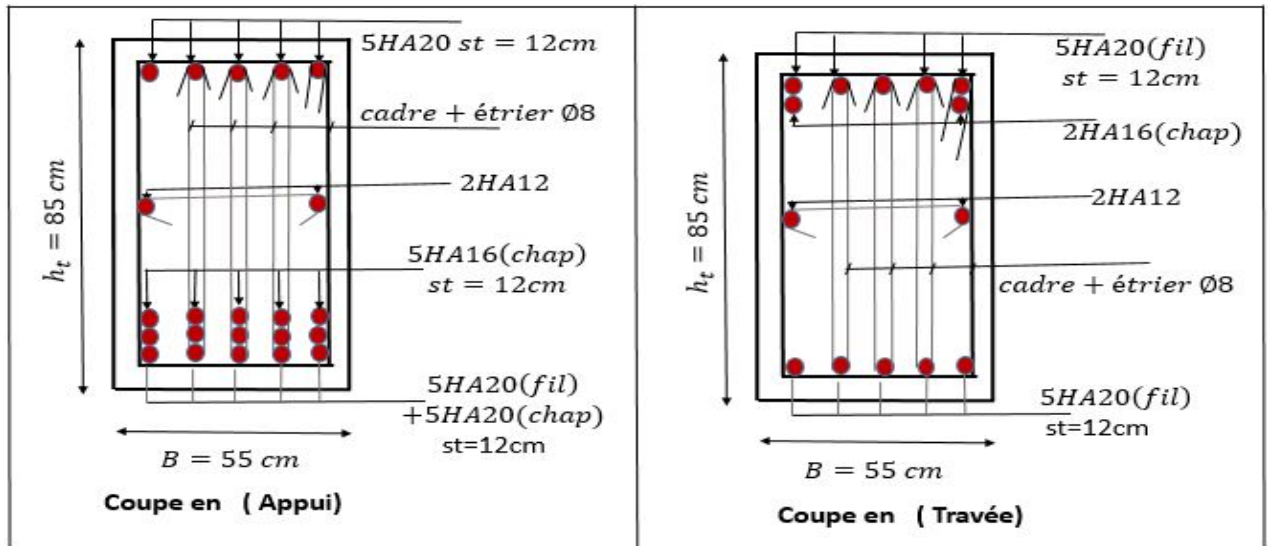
Schéma de ferrailage de la poutre de rigidité (fille B)
